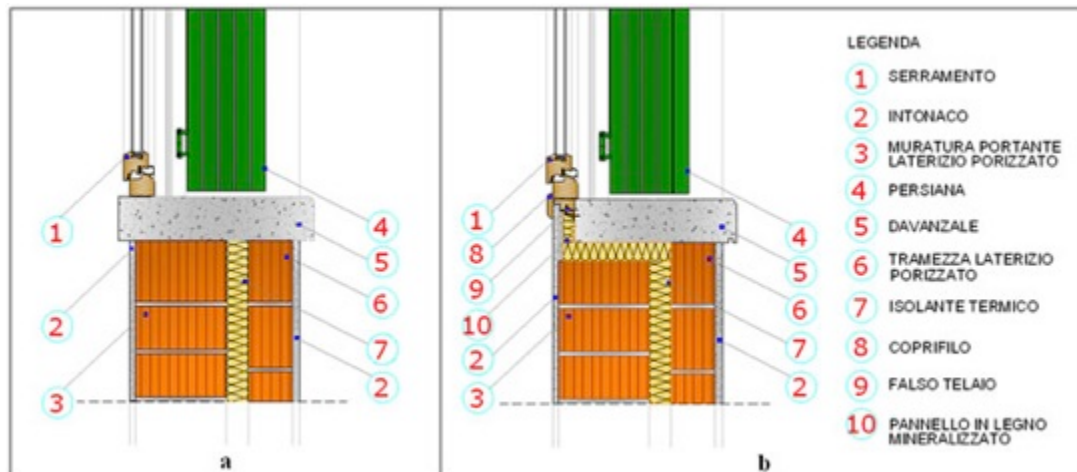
Schema di soluzione ponte termico muratura - infisso
